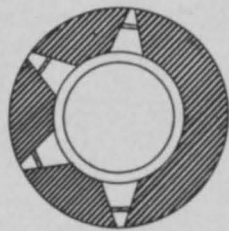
Fürstenwalde. Mauerturm, Grundriß.
